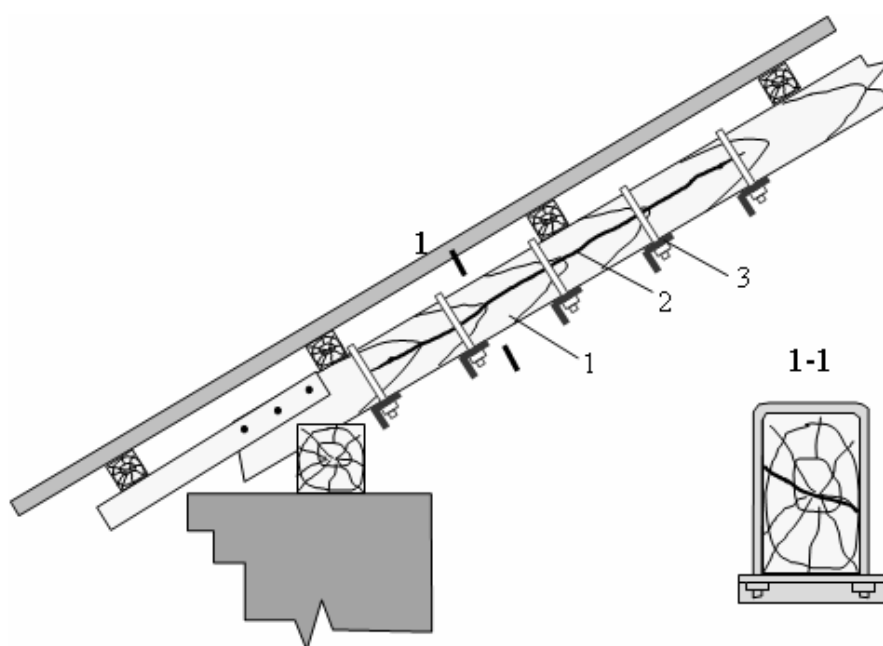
Усиление деревянных элементов с продольными трещинами:
